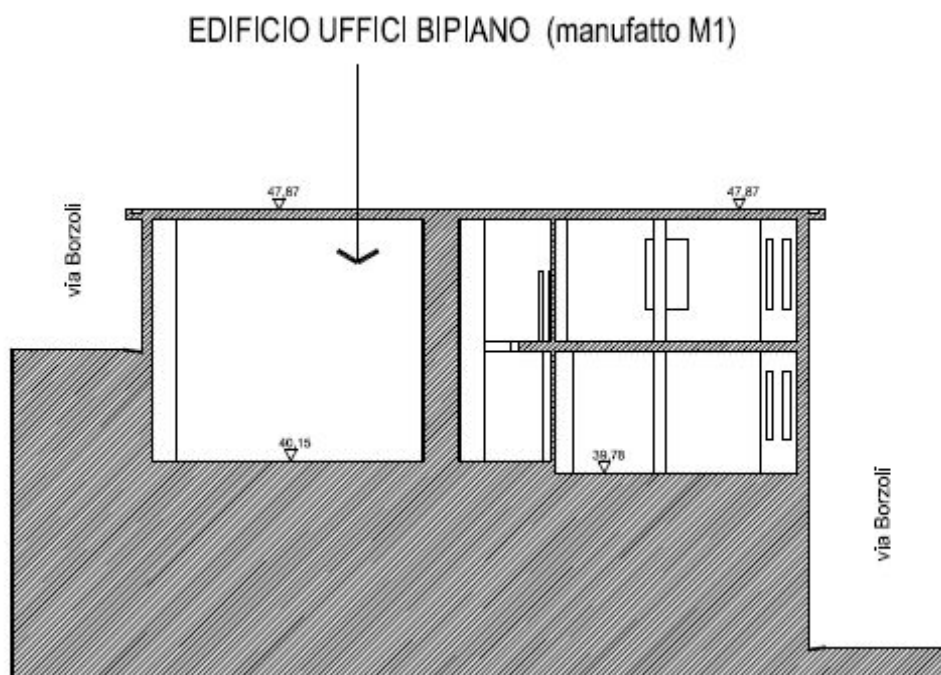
Sezione longitudinale cantiere in fase 2 (edificio M1)
